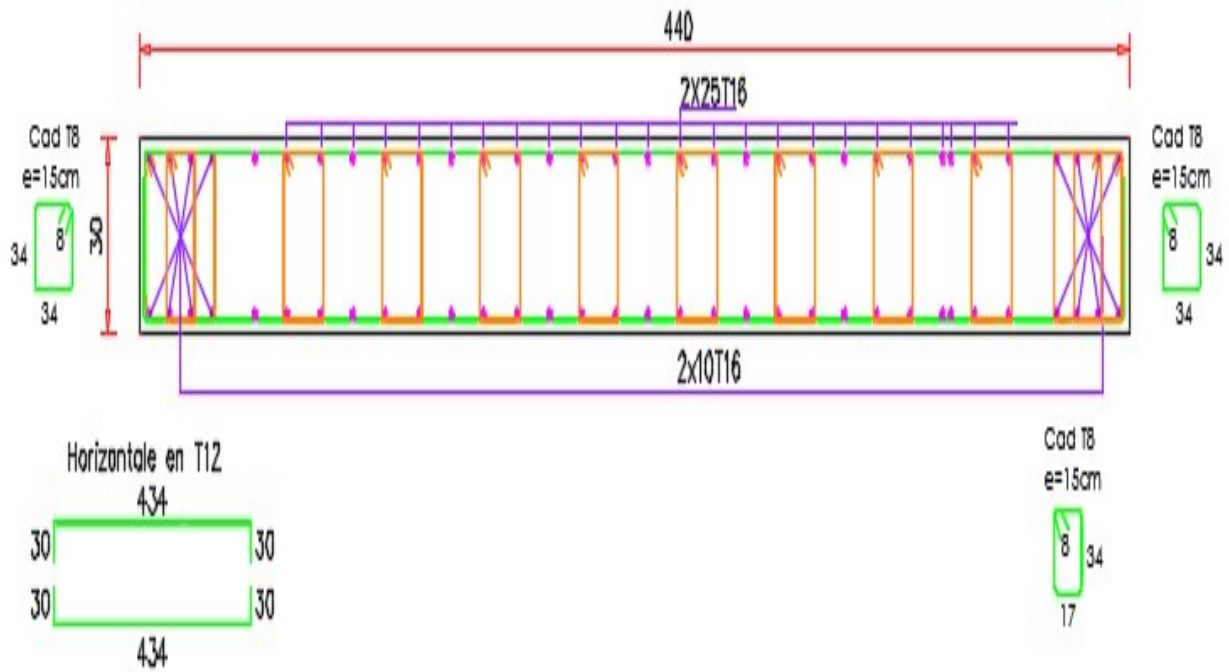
Schéma de ferrailage pour les voiles de longueur L= 4.40m
